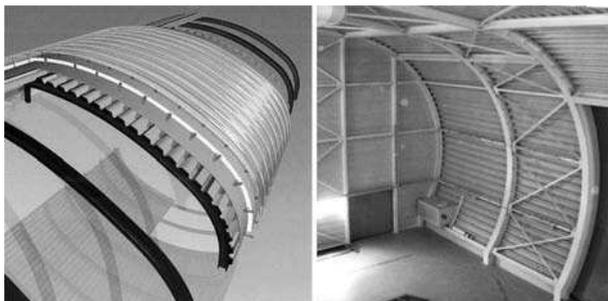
Tragende Dach- und Wandunterschale aus Stahltrapezprofilen auf gekrümmter Unterkonstruktion
